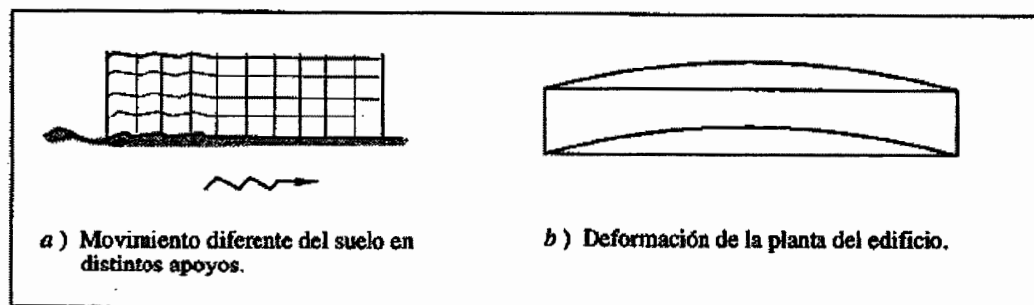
Problemas de configuración en planta, por alas muy alargadas
